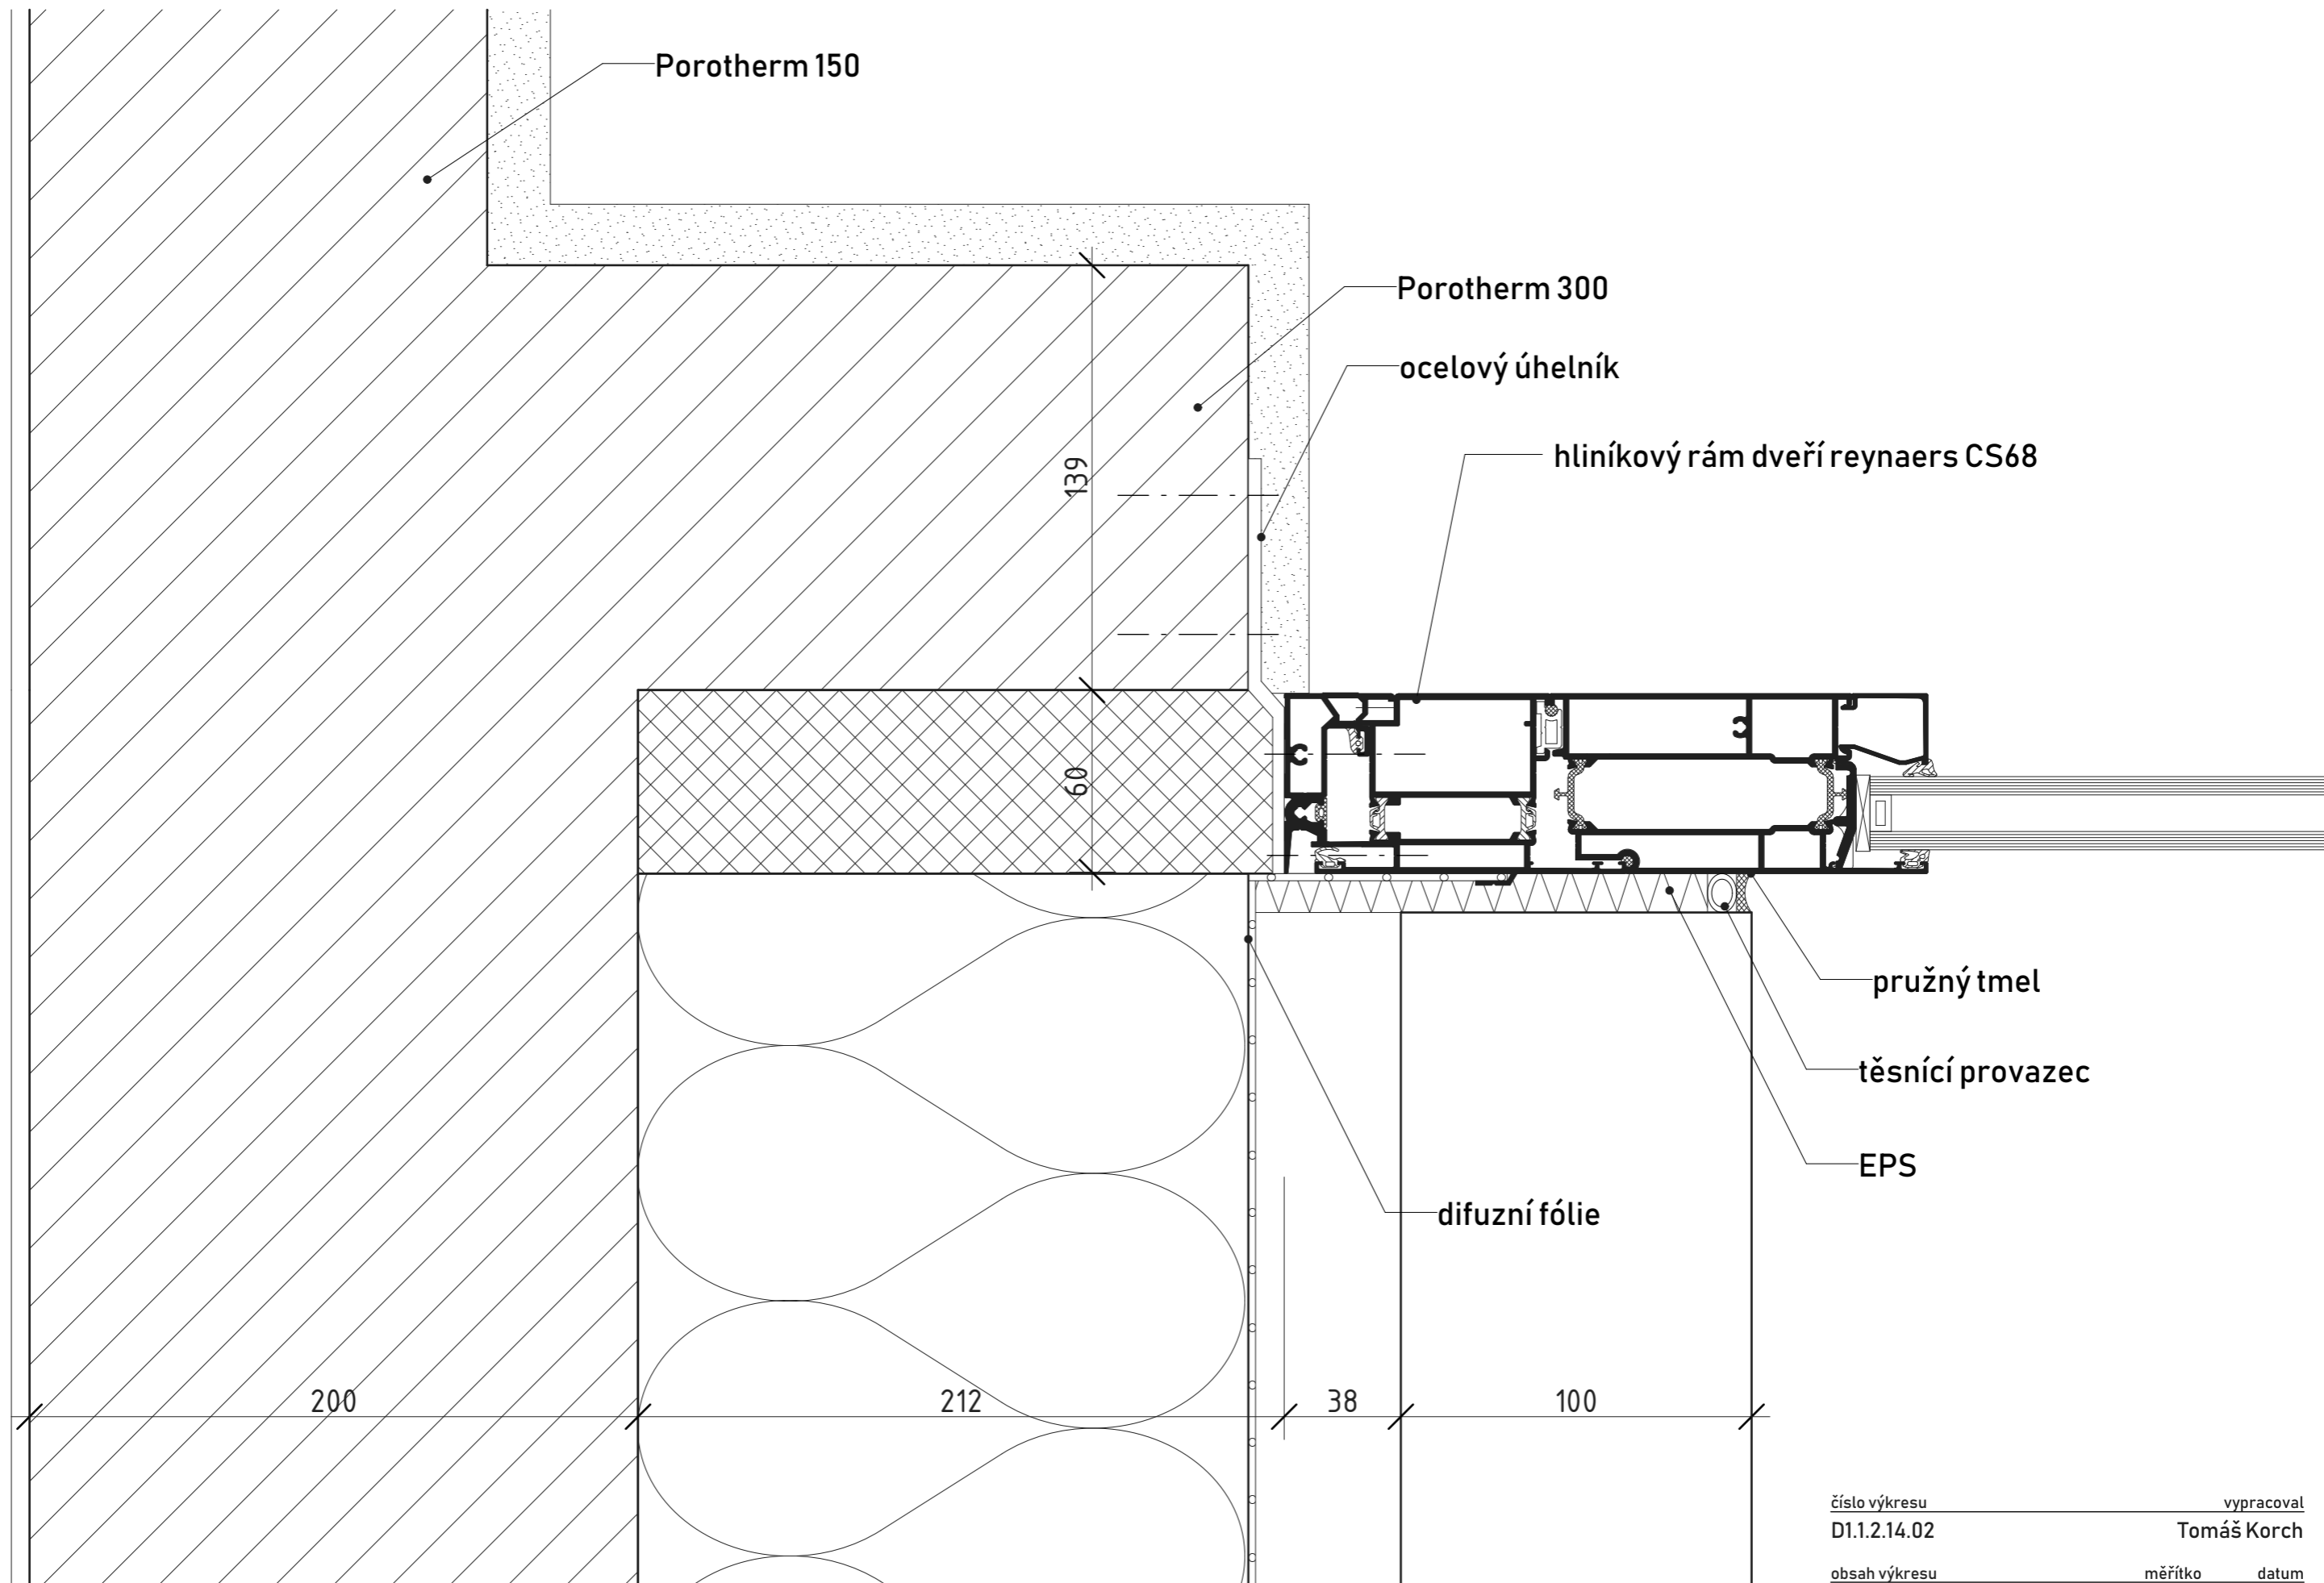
PRÁH VSTUPNÍCH DVEŘÍ
